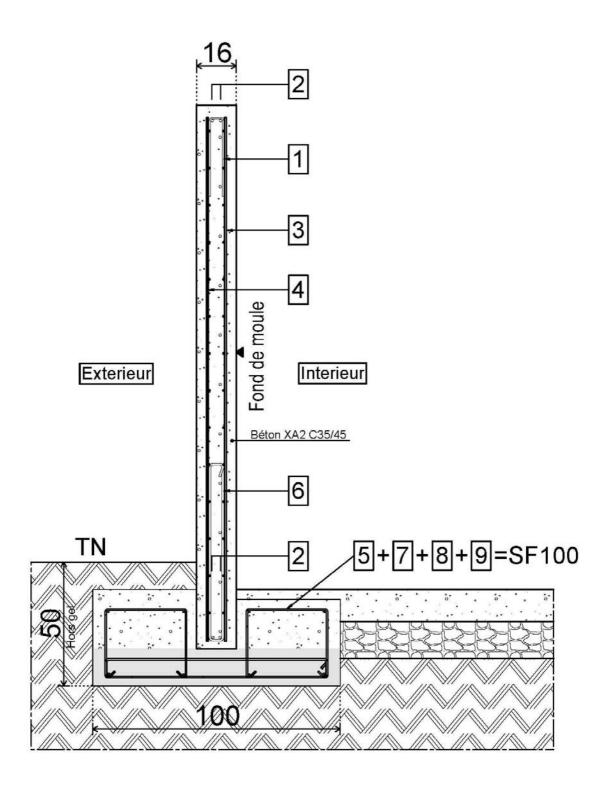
Coupe sur voile extérieur fumière (épaisseur 16 ou 20cm)
